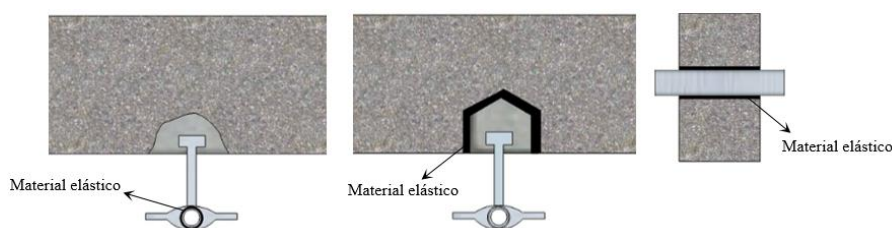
Formas de fixação e de atravessamento de tubagens
